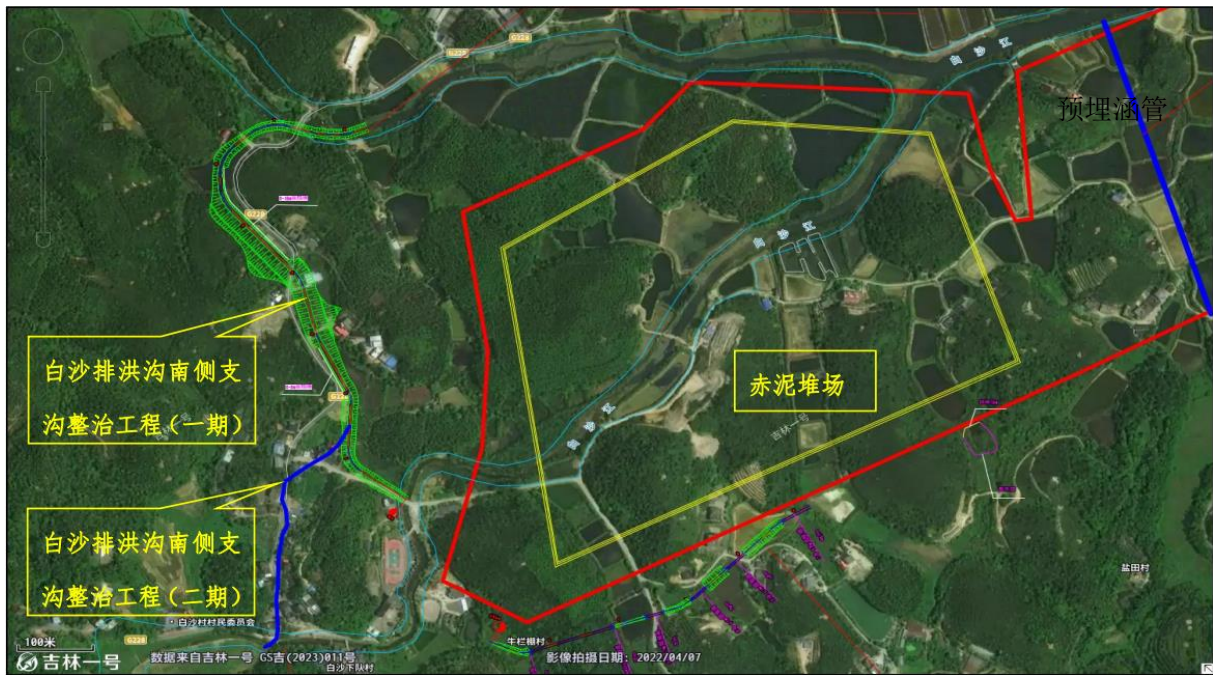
赤泥堆场与白沙沟整治工程平面布置图
